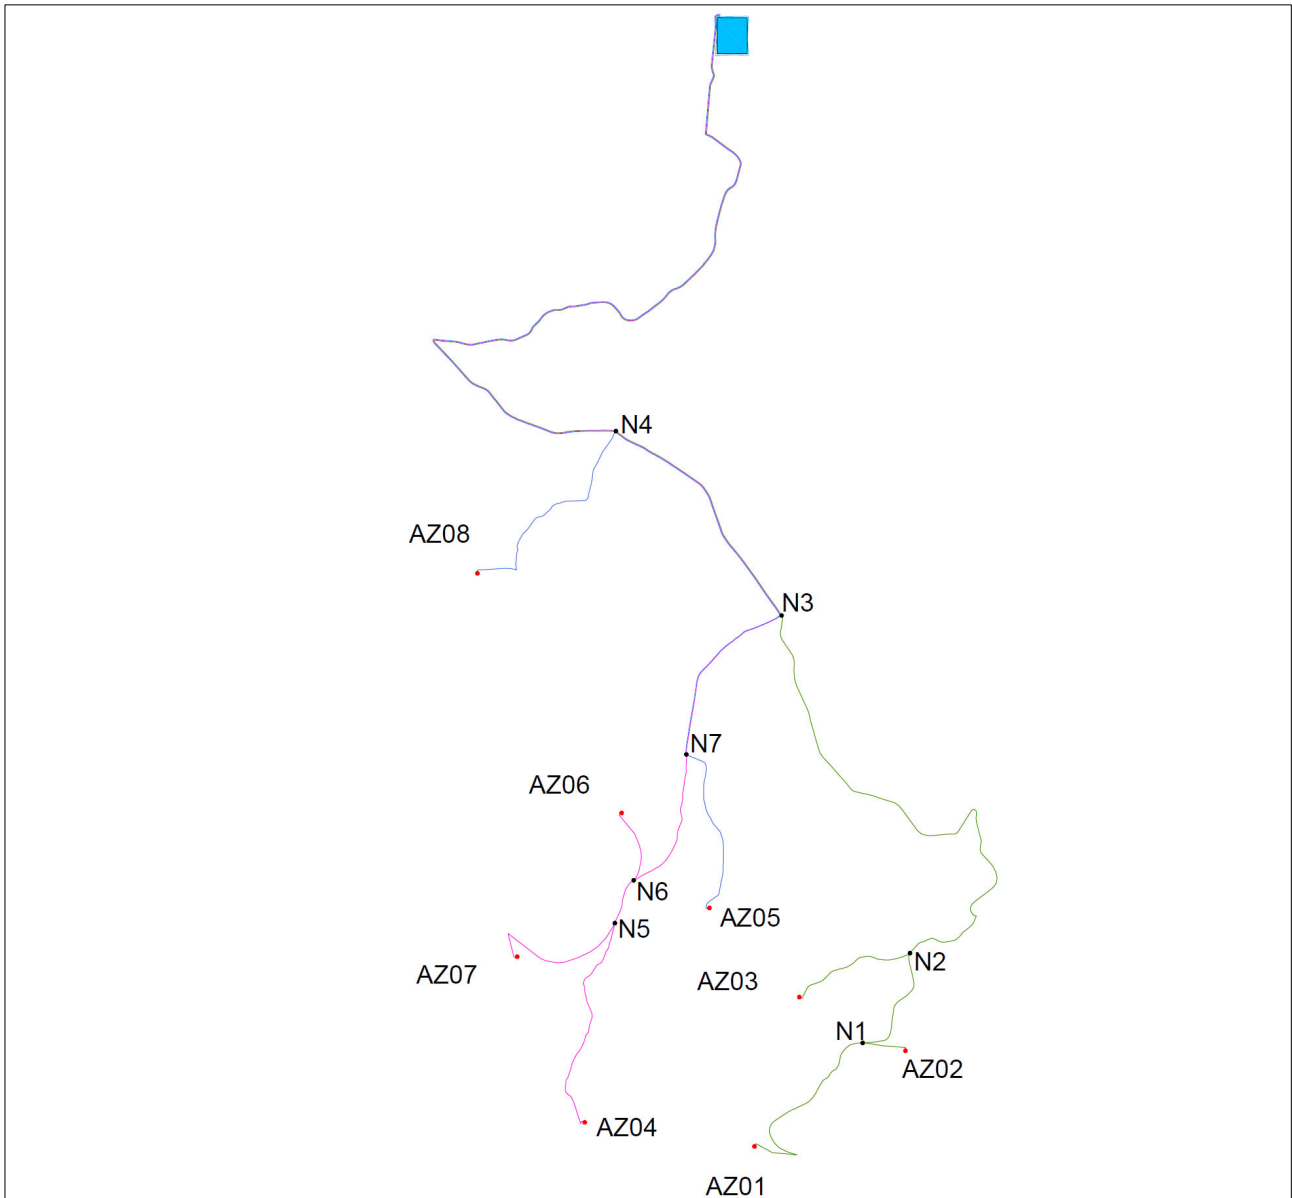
Planimetria generale di distribuzione della linea a 36 kV
